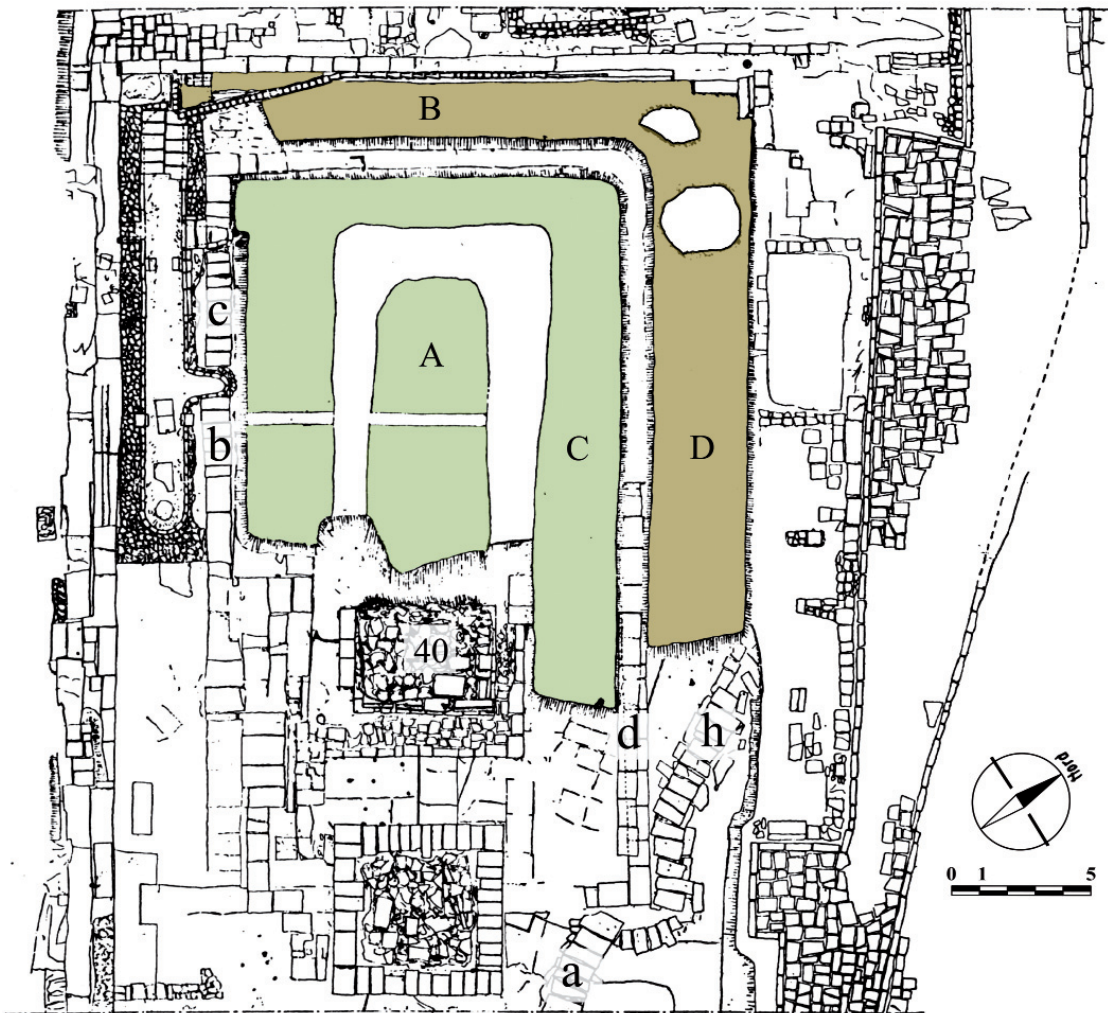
Planimetria della terza fase edilizia del “Tempio monumentale”: sono indicate le pavimentazioni in «calcestruzzo» (lettere A, C) e in battuto (B, D), le strutture murarie (b-c, d) e la canaletta (a-h) (Elab. dell'A. da PESCE 1961b)
